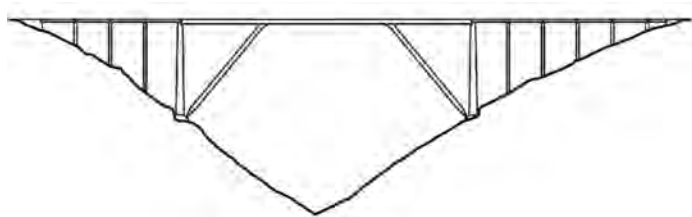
Schema Viaductului Stalassa, structură nesimetrică cu stâlpii înclinați, articulați în fundațiile pilonilor principali
